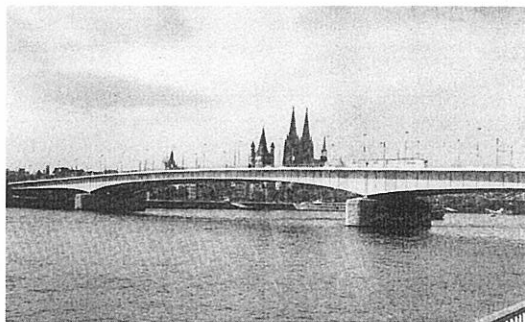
KÖLN-DEUTZ橋 (西ドイツ)¹⁾
